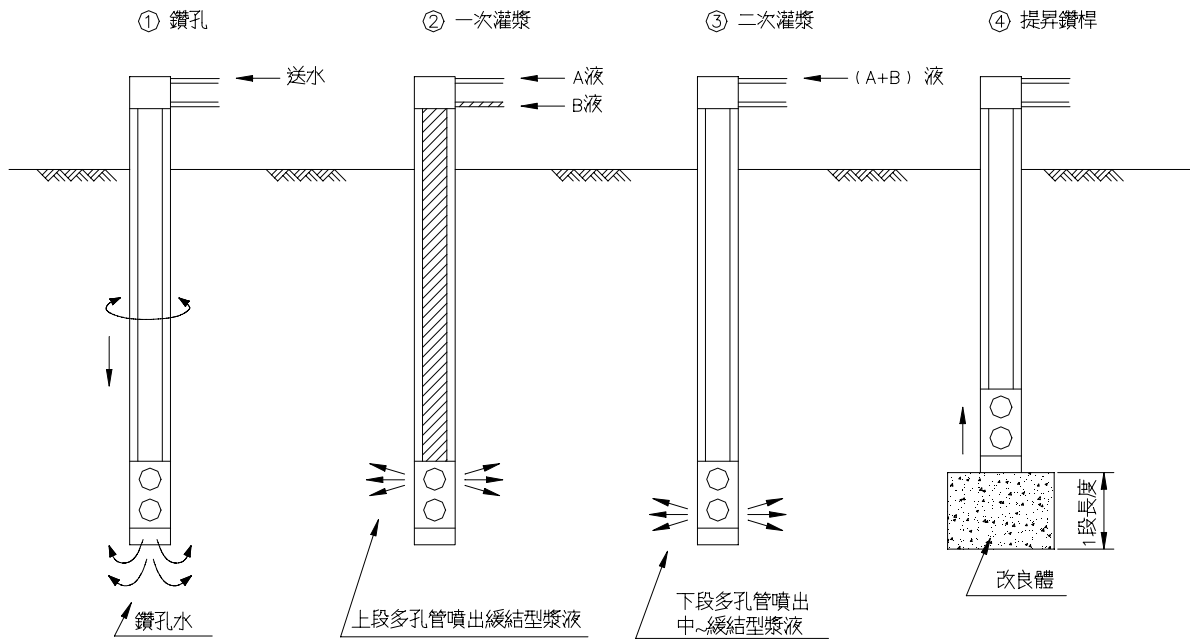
雙重管灌漿工法(複相式多孔管)施工示意圖
